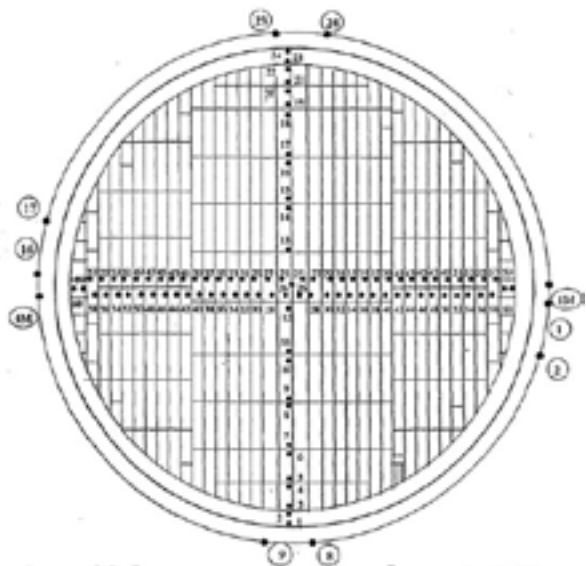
Схема контроля толщины плавающей крыши резервуаров
